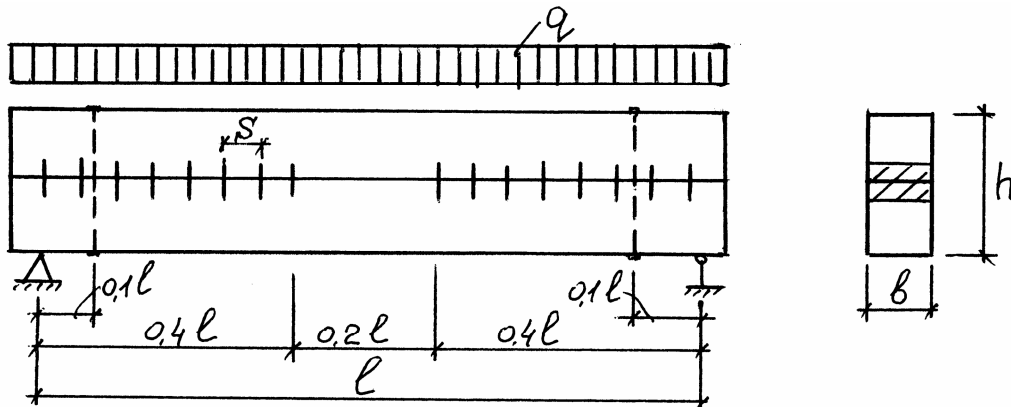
Розрахункова схема балки на пластинчастих нагелях
